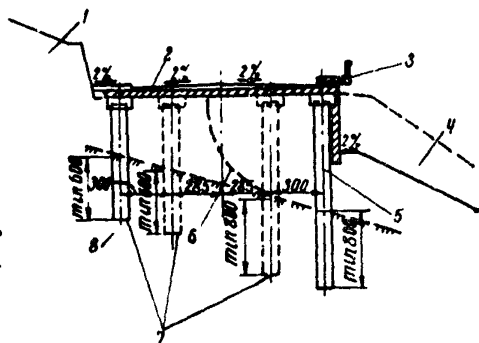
Свайное поле с железобетонным ростверком под проезжей частью на всю ее ширину:
